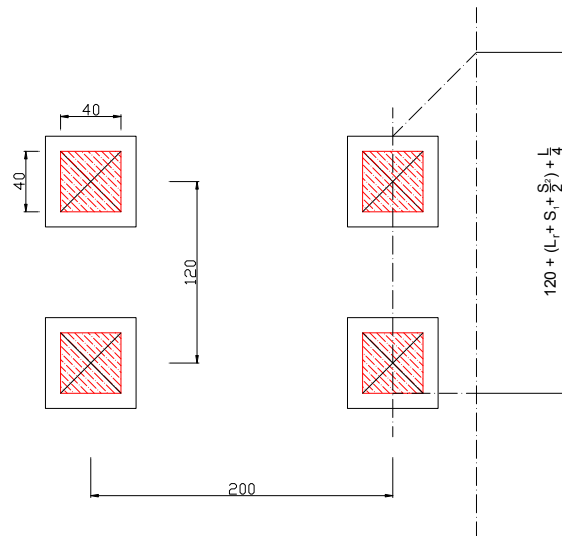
Diffusione su sezioni di giunto spalla
